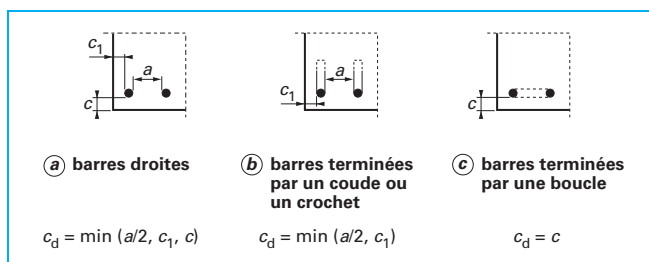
Valeurs de c_d pour les poutres et les dalles (figure 8.3 de l'EC2)
